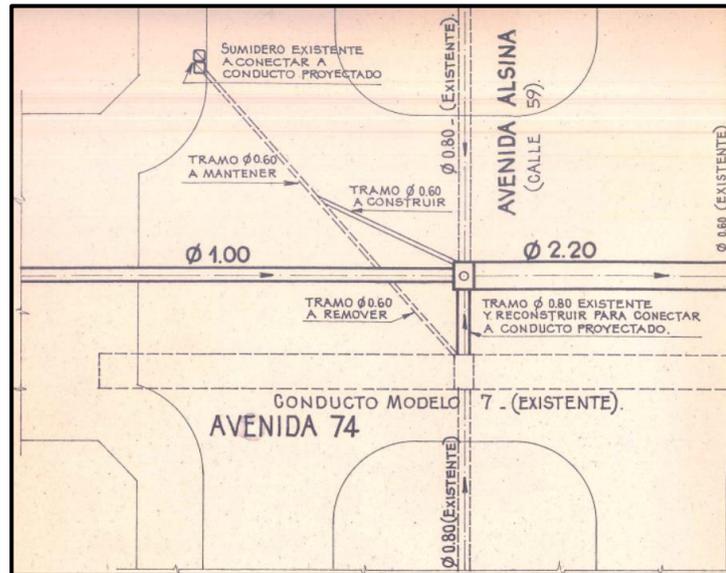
Detalle de esquina Avenida 74 y Avenida 59
